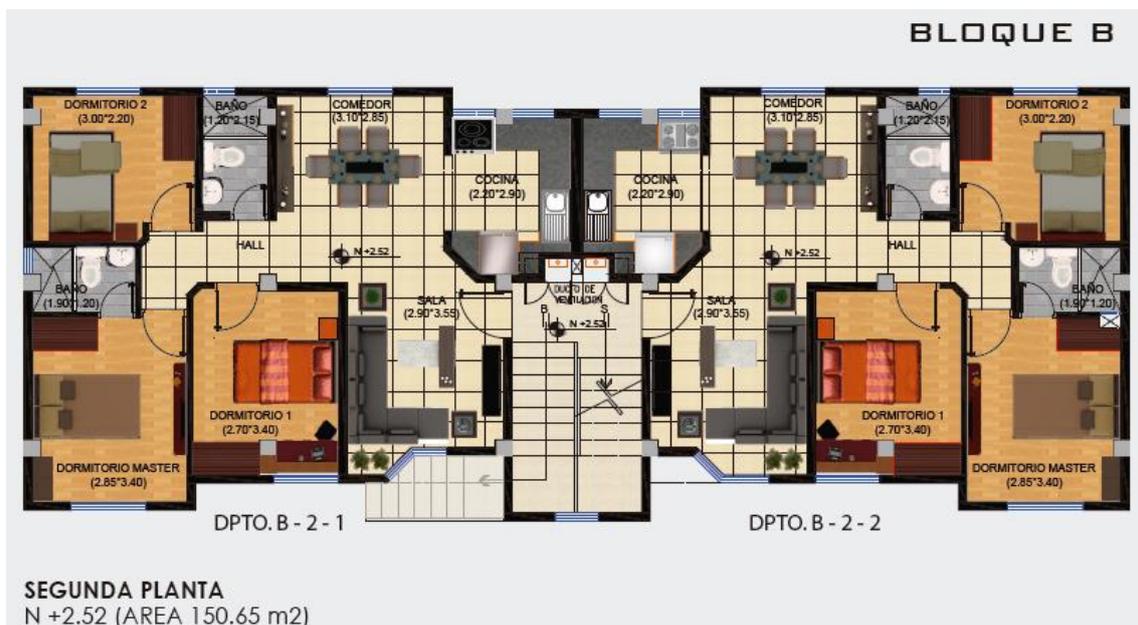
Segunda Planta N+2.52 Bloque “B” Departamentos
